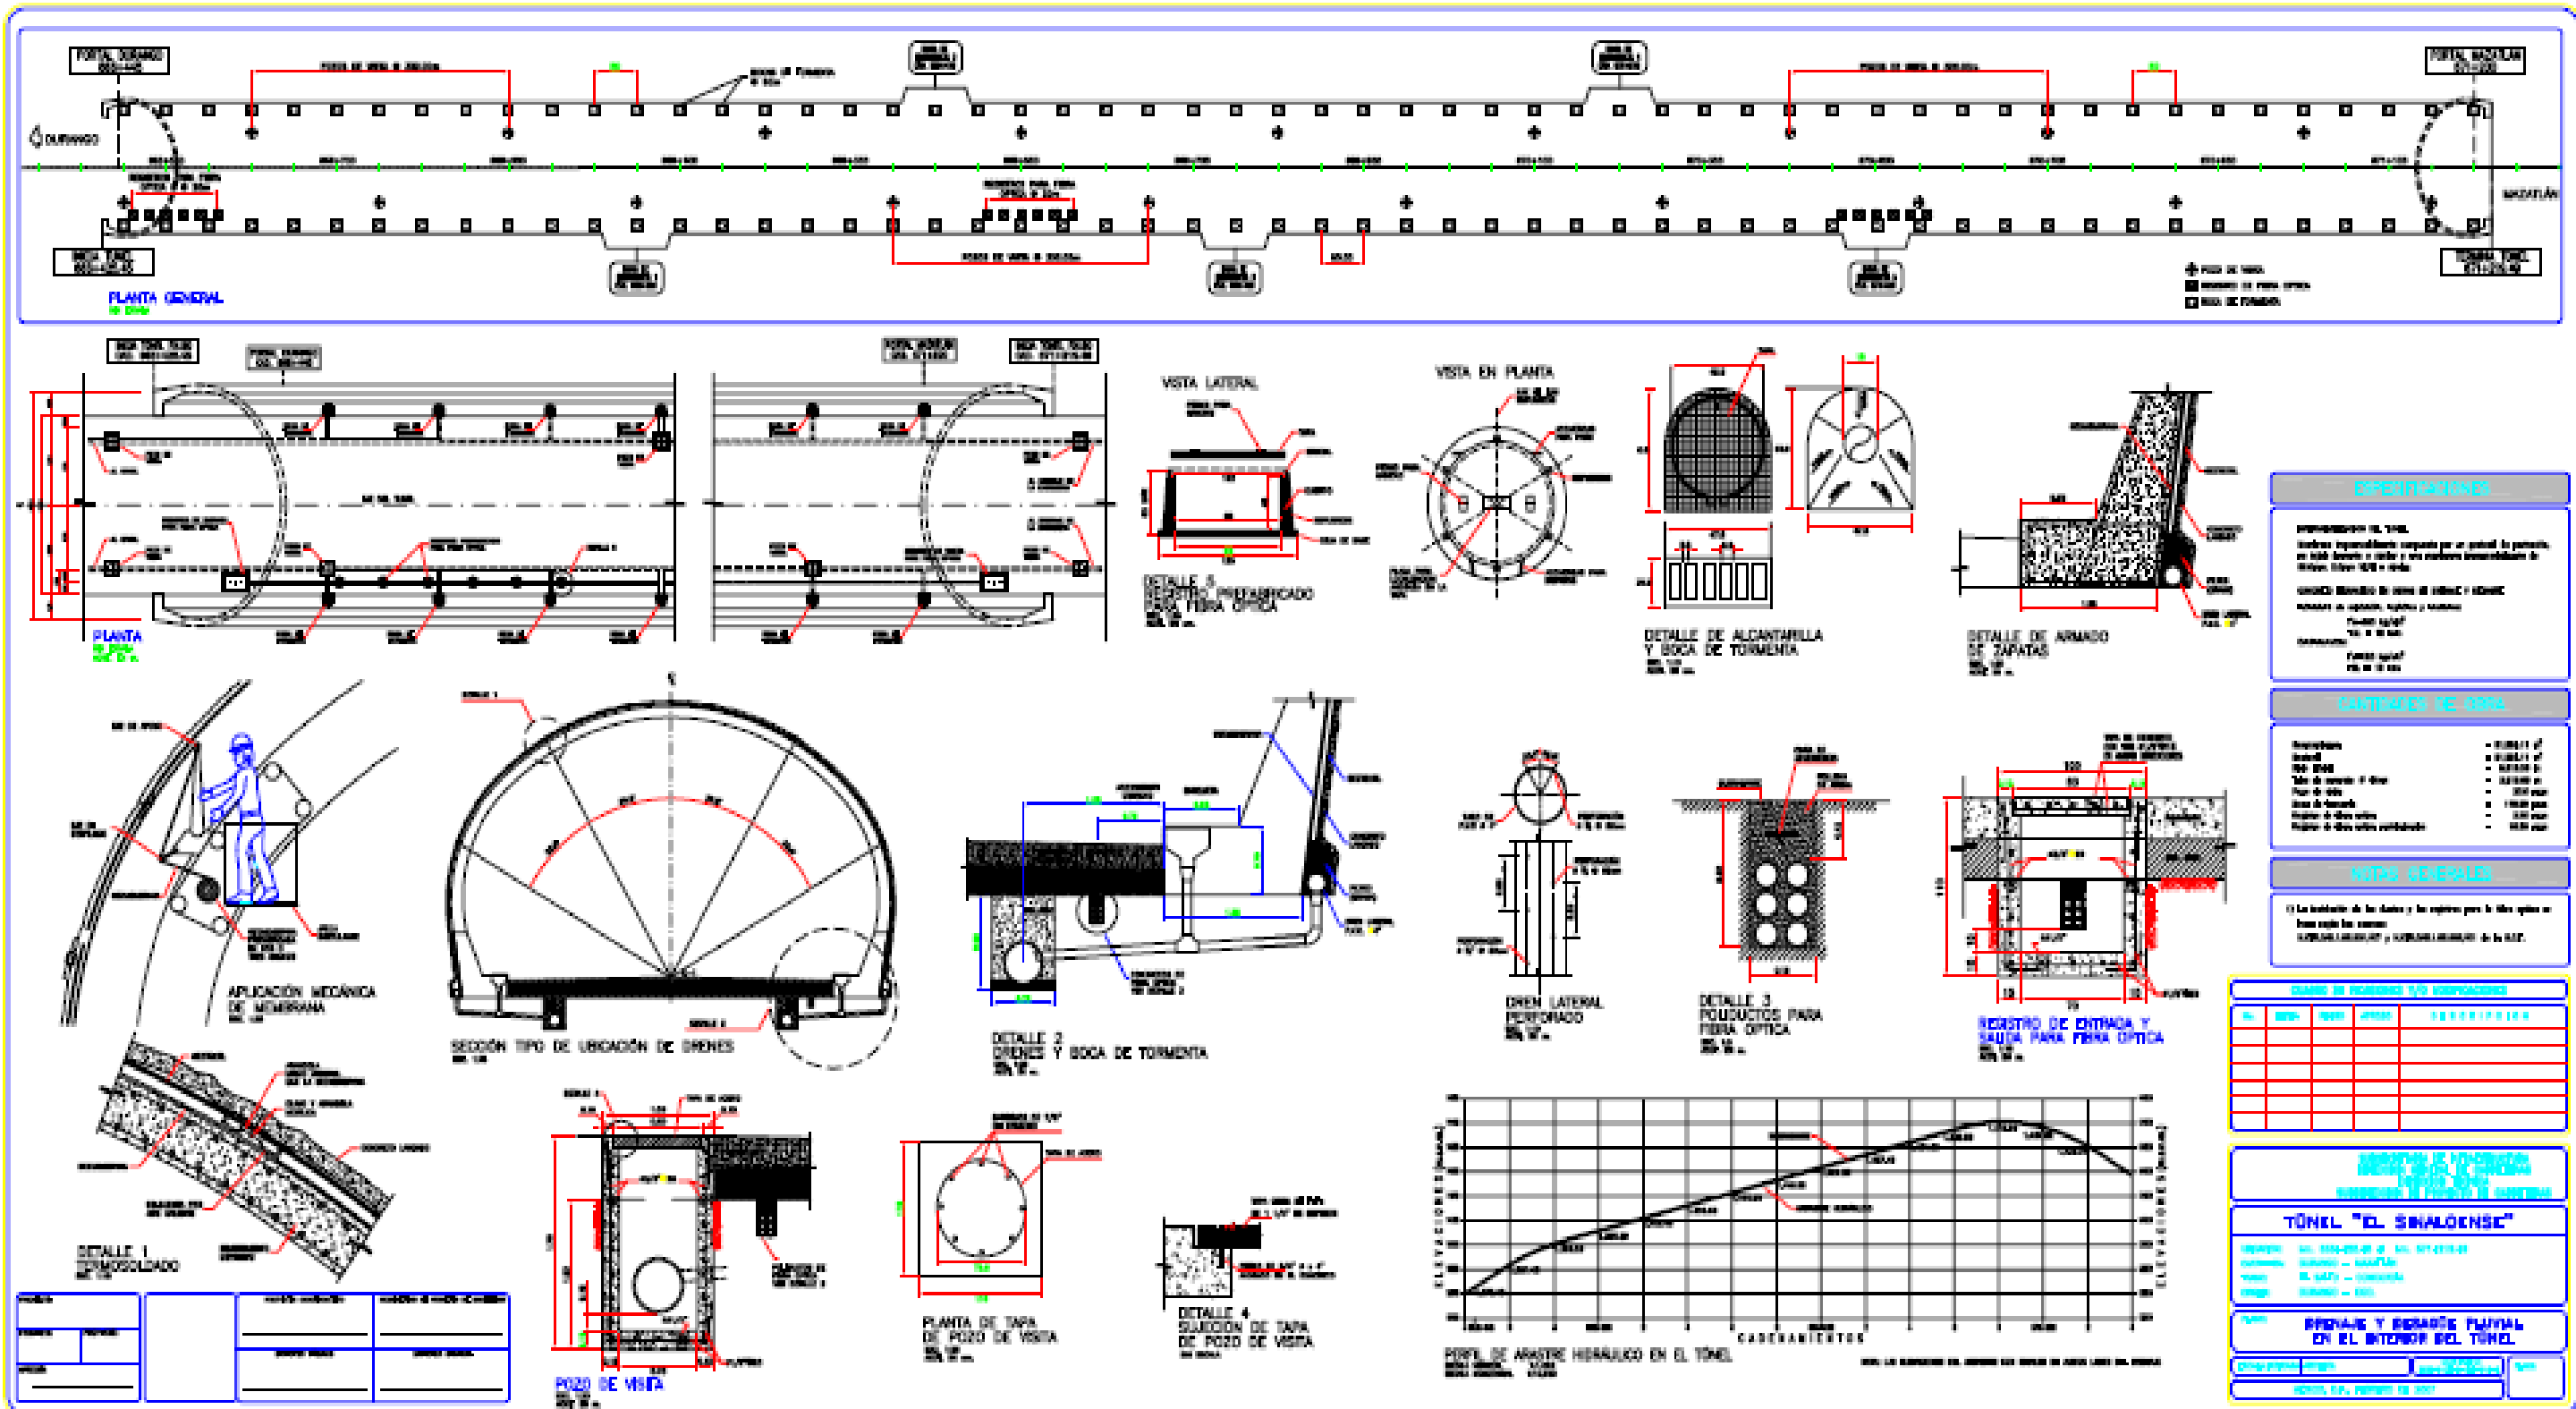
Planos del Drenaje en el Túnel Sinaloense
